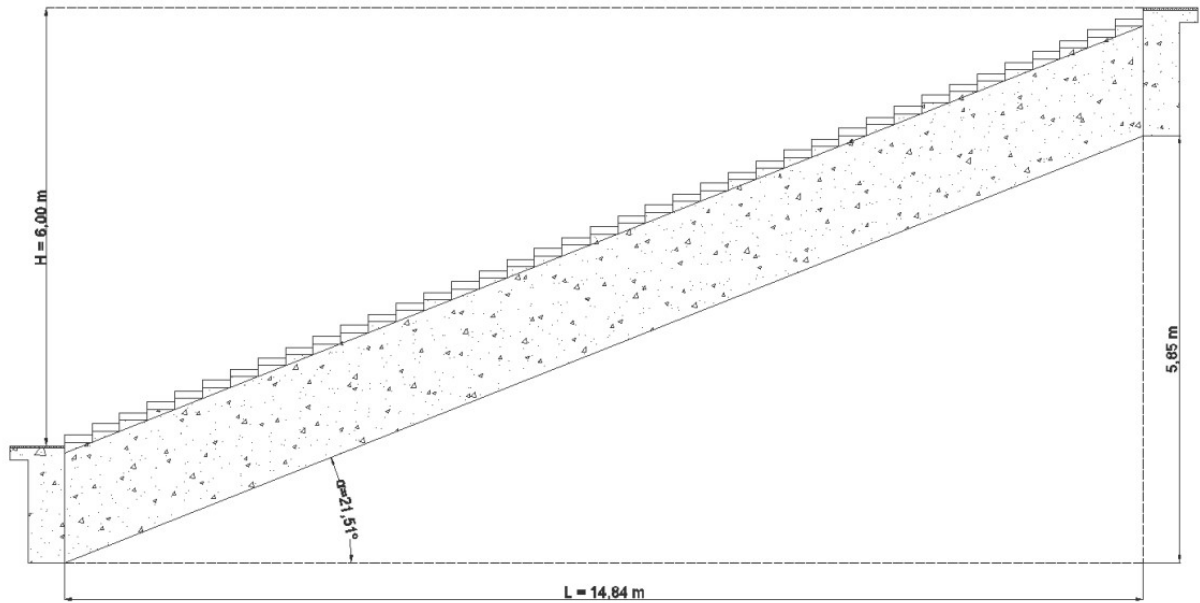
Dimensões da escada em planta baixa. Fonte: Noal, 2014
